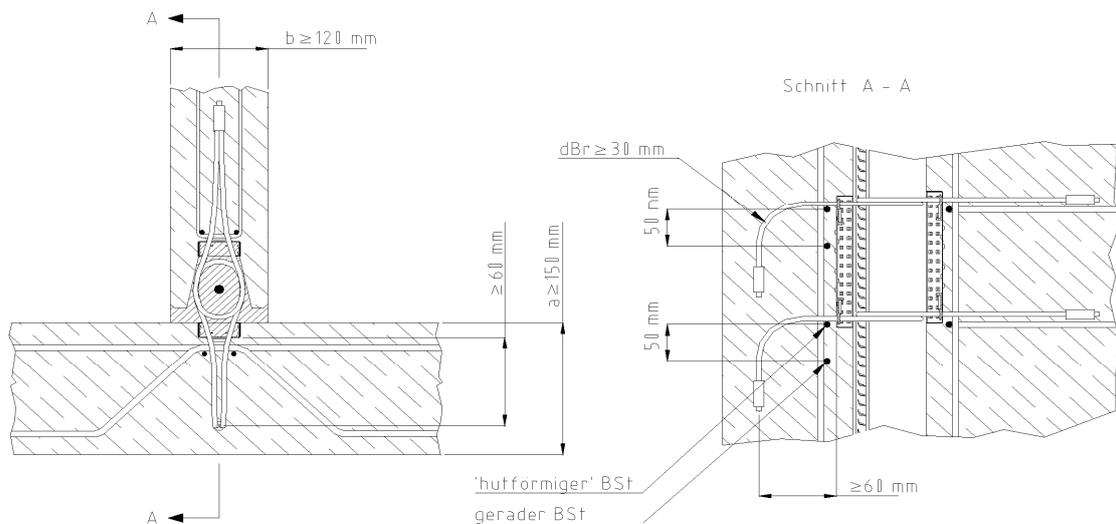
Wand – Wand – T-Verbindung - Detail mit abgewinkelten Seilschlaufen
